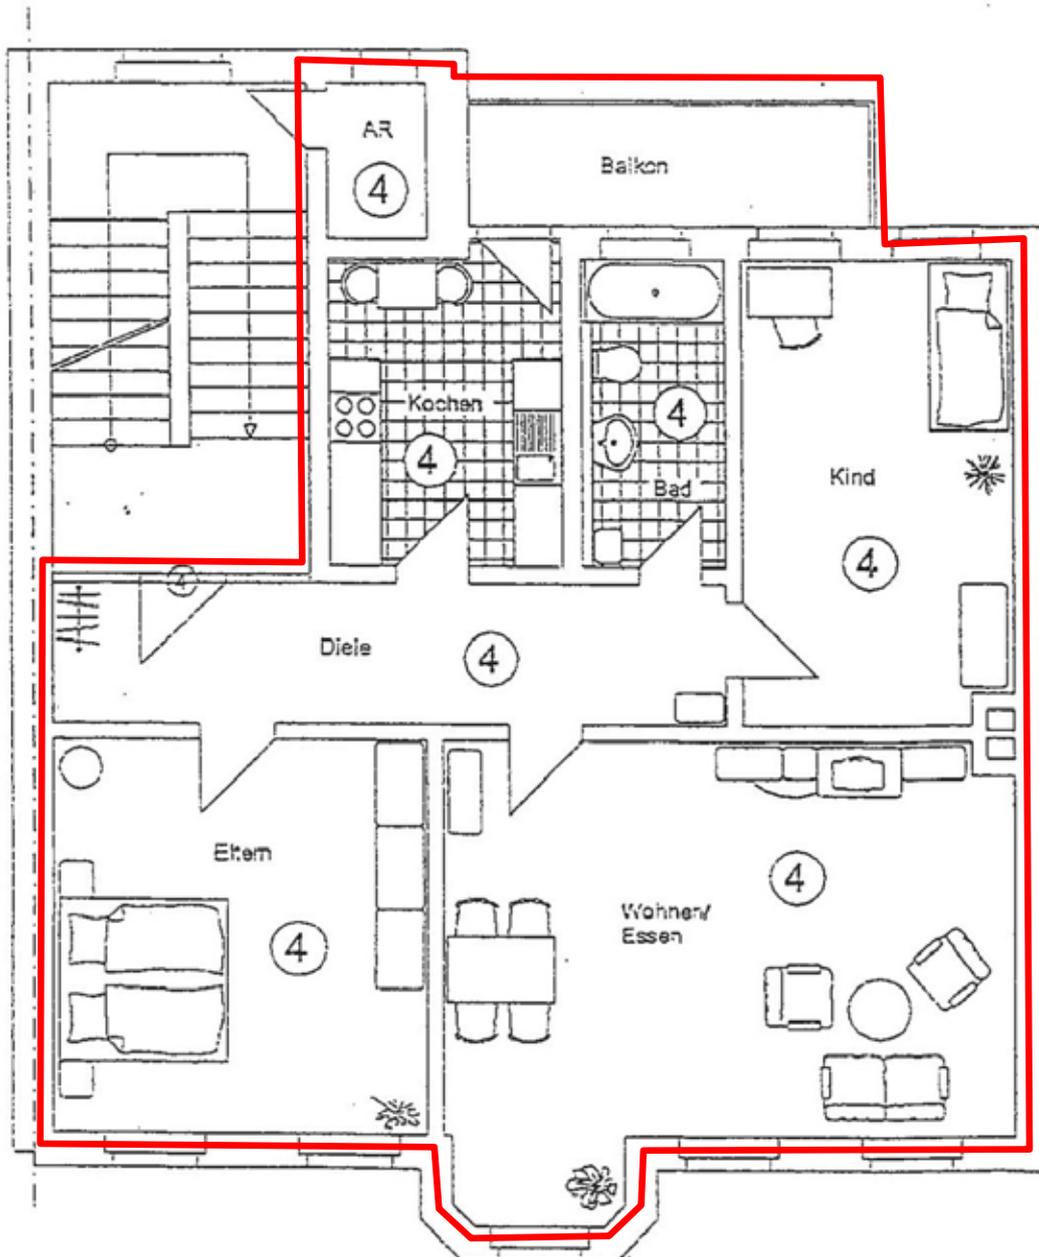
Grundriss des 2. Obergeschosses
